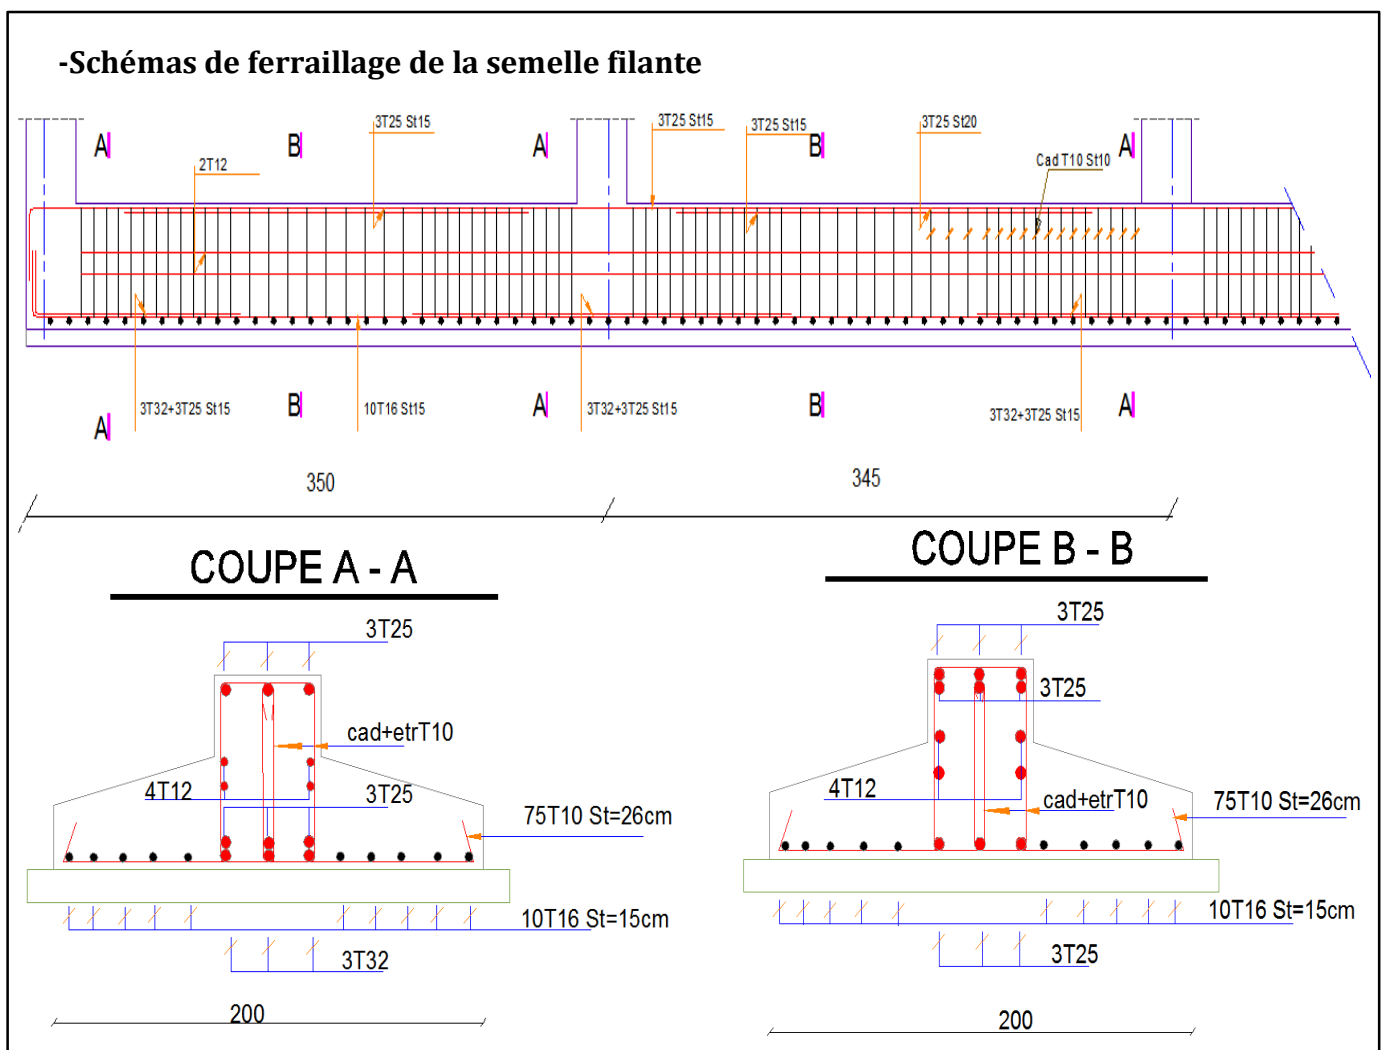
3 : schémas de ferrailage de la semelle filante type1 selon X-X
